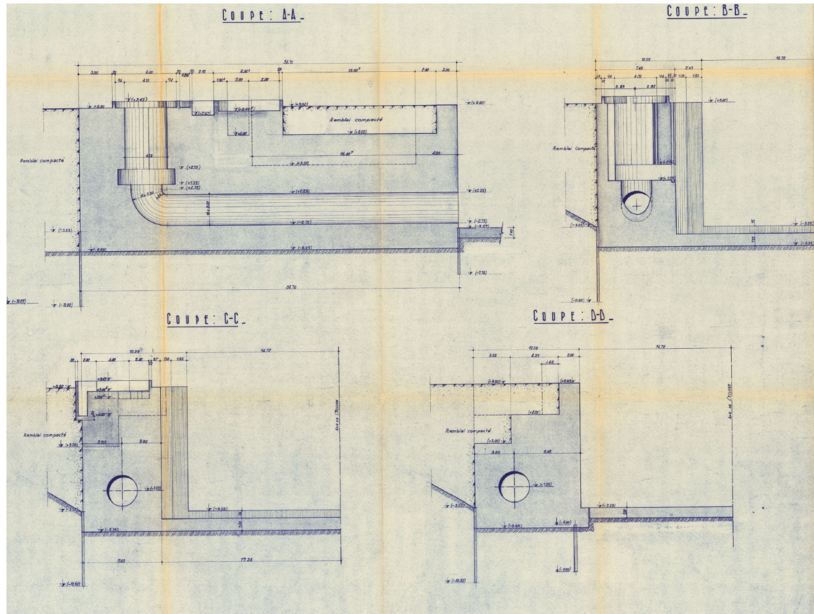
Demi-tête aval Ouest – Coffrage – Détail – Coupes AA, BB, CC, DD (plan 65 archives DREAL)
